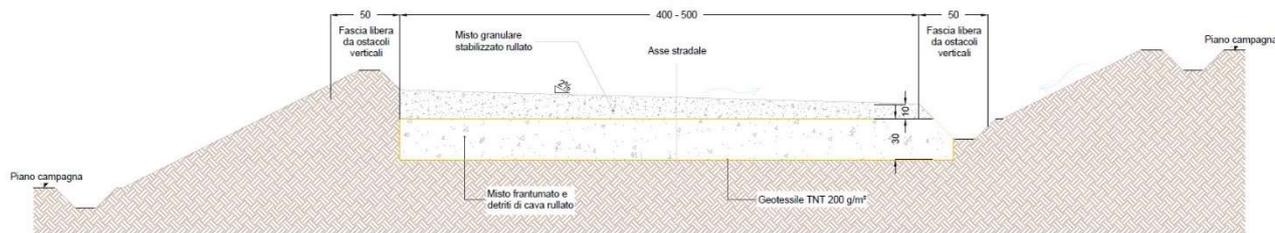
Sezione tipo pista di impianto a mezzacosta; misure in centimetri.
